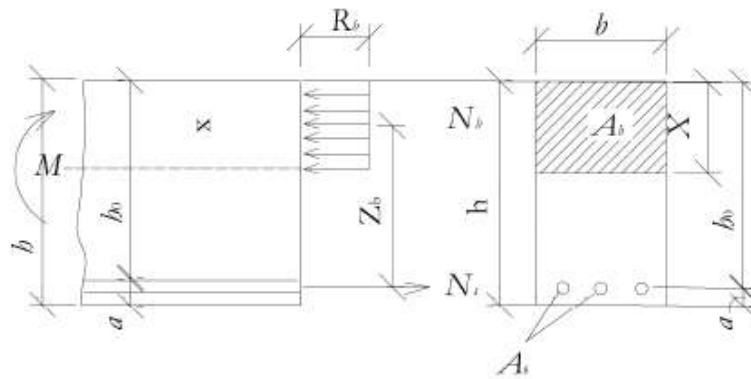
Для розрахунку перерізу згинального елемента прямокутного форми з подвійною арматурою
